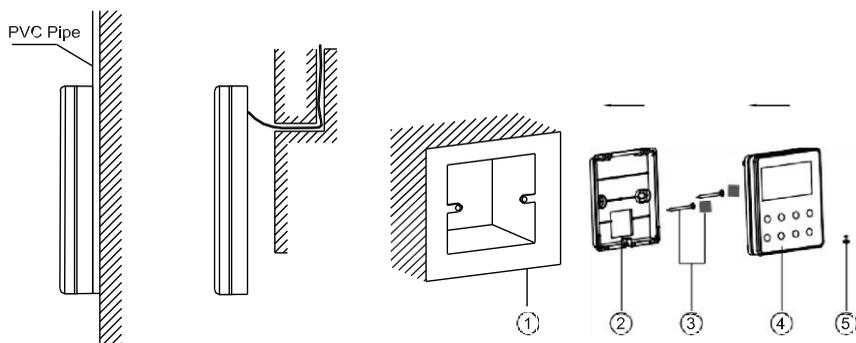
Acessórios para a Instalação do Comando Remoto por Cabo
